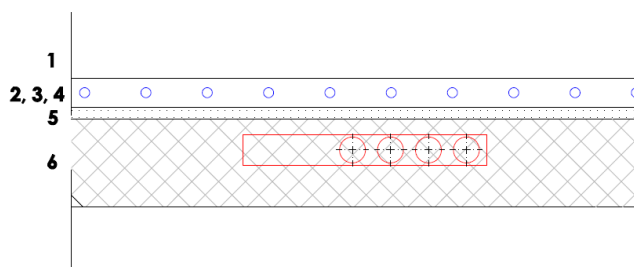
Particolare del solaio SOL-3 tra il secondo e il terzo piano indicante i terminali del sistema di climatizzazione e ventilazione
